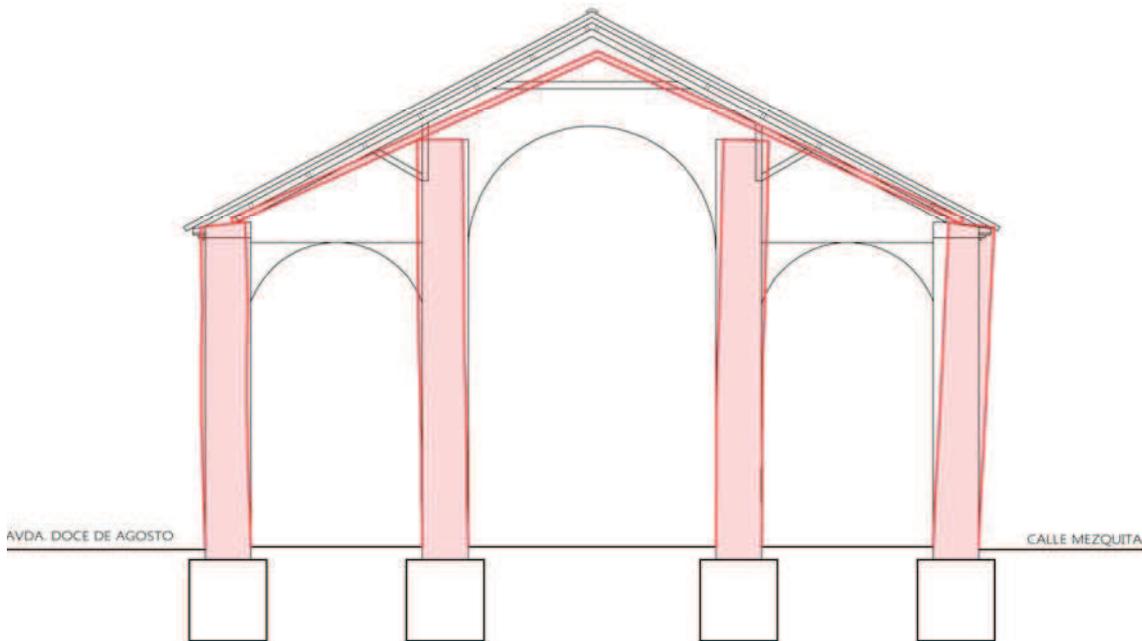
Croquis de deformación de la estructura sobre la sección teórica
